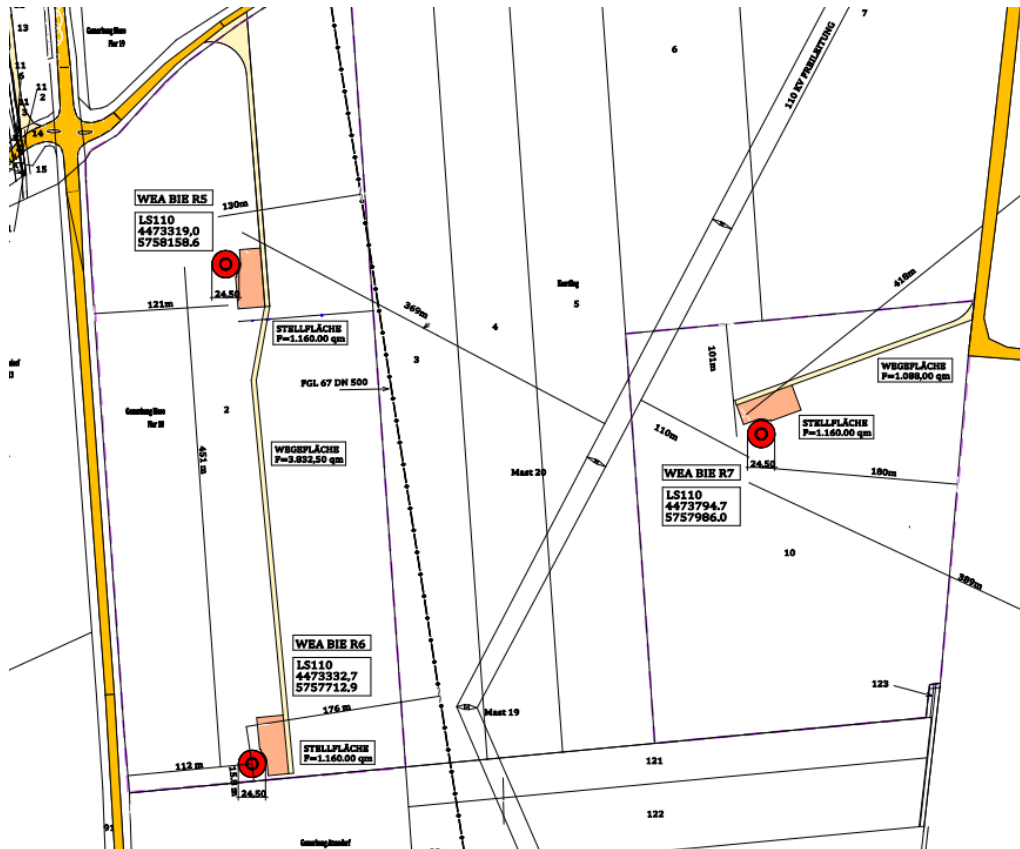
Detaillageplan der geplanten WEA inkl. Zuwegungen (Südteil)
